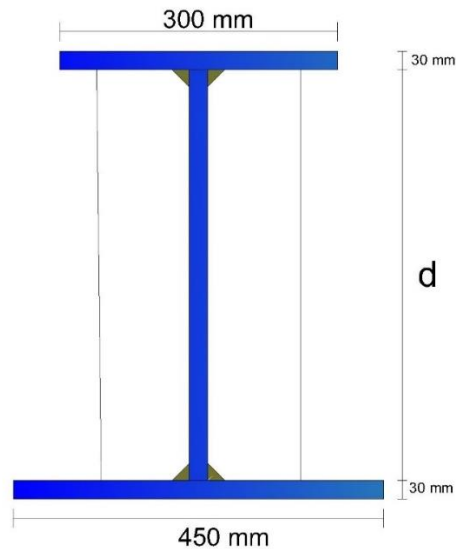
60: Ubicación del cordón de soldadura patín superior e inferior con el alma de viga (vista frontal)
